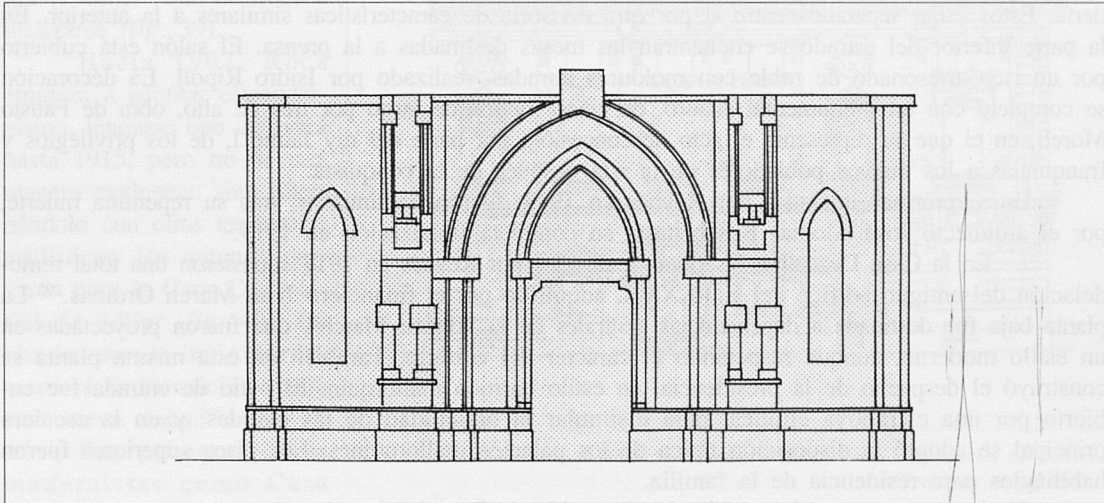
G. Reynés. Iglesia de Santa Tecla. Proyecto de fachada (1911).
